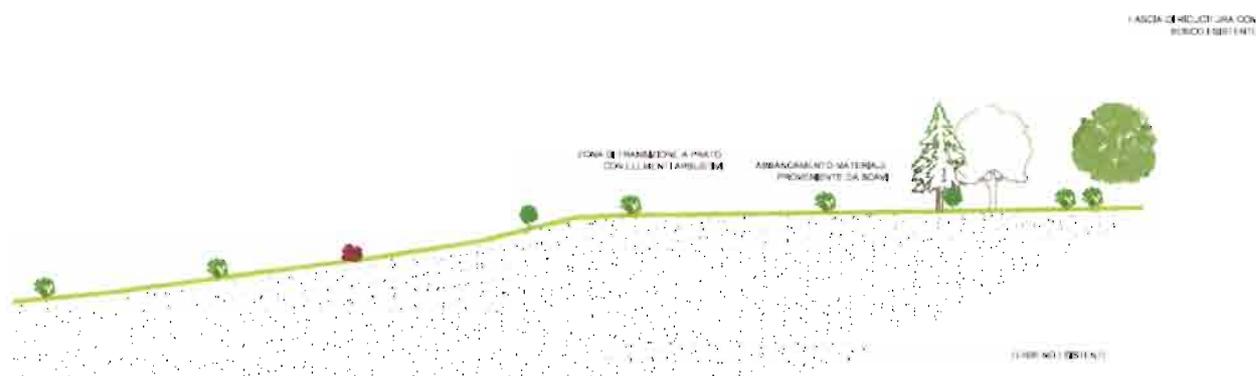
Sezione A-A' della planimetria delle opere a verde in corrispondenza del deposito definitivo Plaikner.
